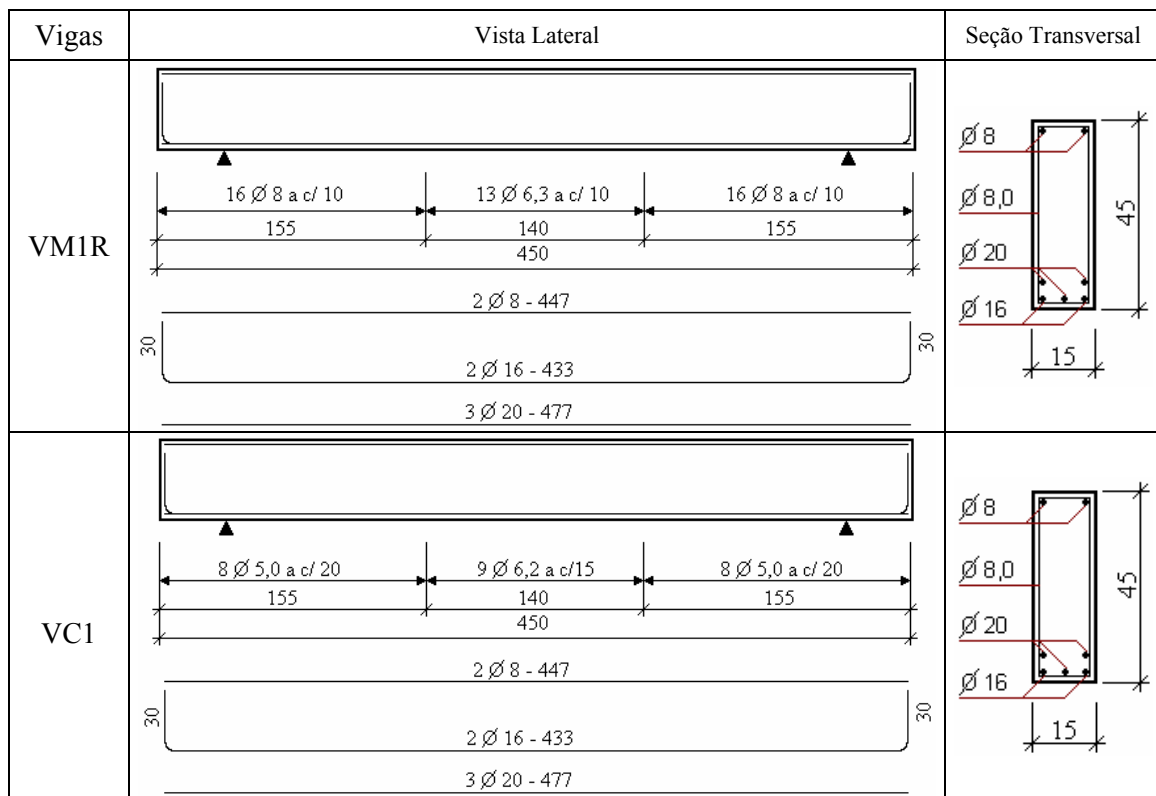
Armaduras das vigas do experimento de ARAÚJO, C.M. (2002)
